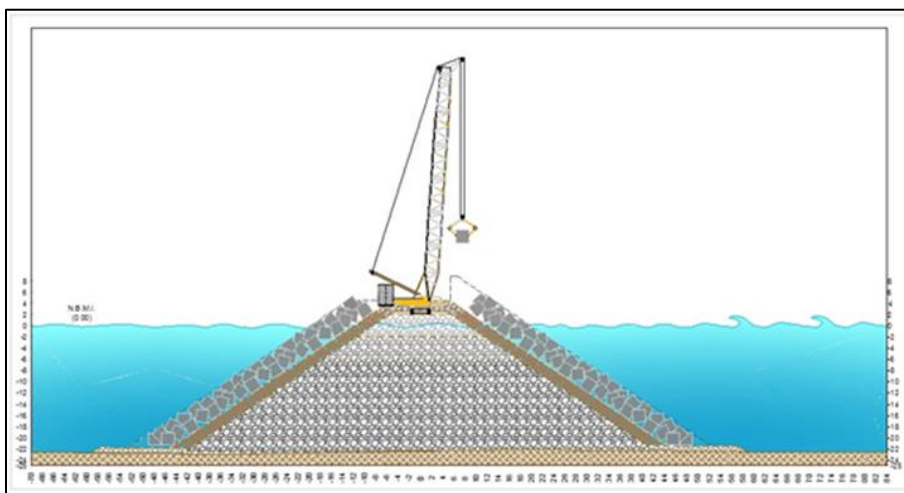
Colocación de Cubos de concreto en coraza con Grúa. Completando la sección de Proyecto. Abastecimiento con vehículos articulados
